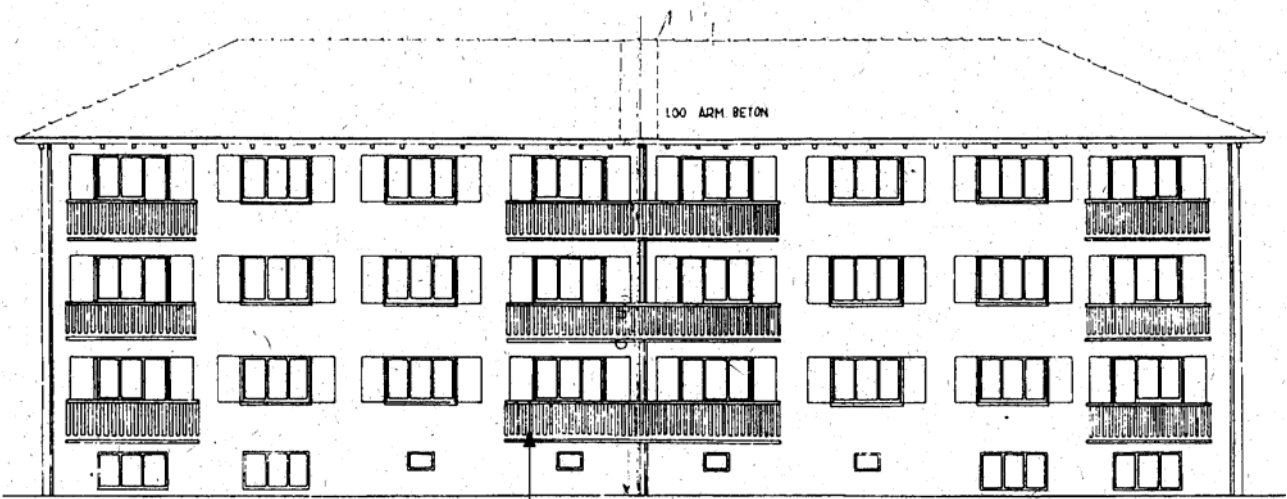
Immeuble Friestrasse 28/30 - Façade Ouest
